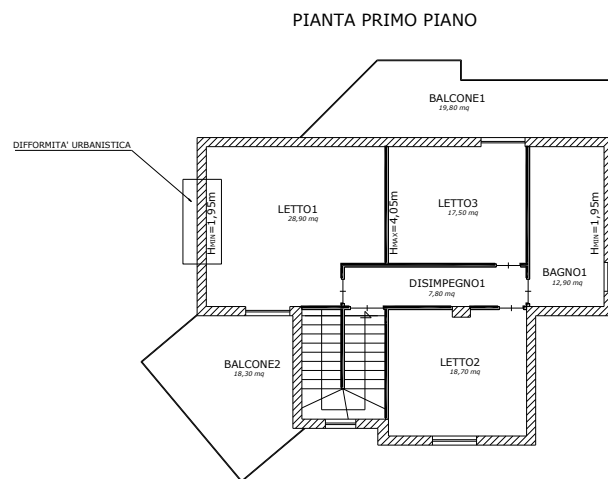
planimetria delle difformità urbanistiche del primo piano della villa
